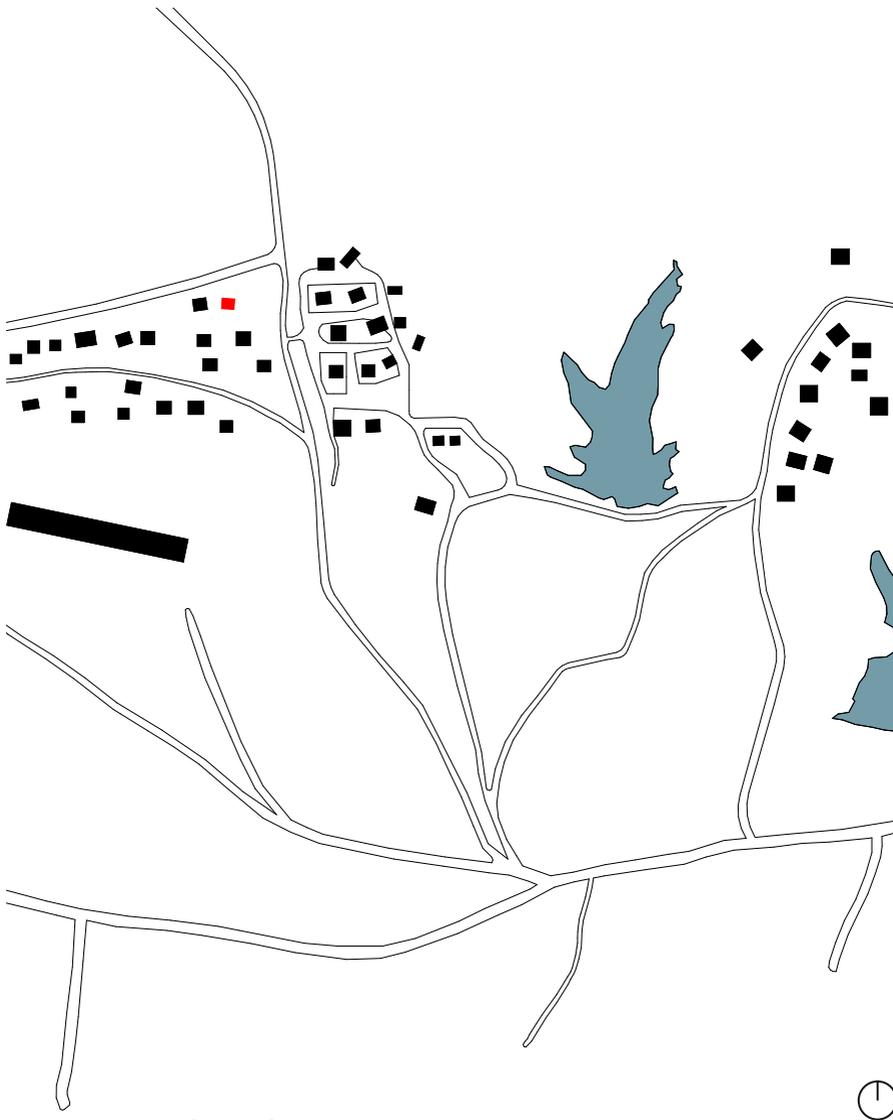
Lageplan Sonsuz Şükran | 1:5000
